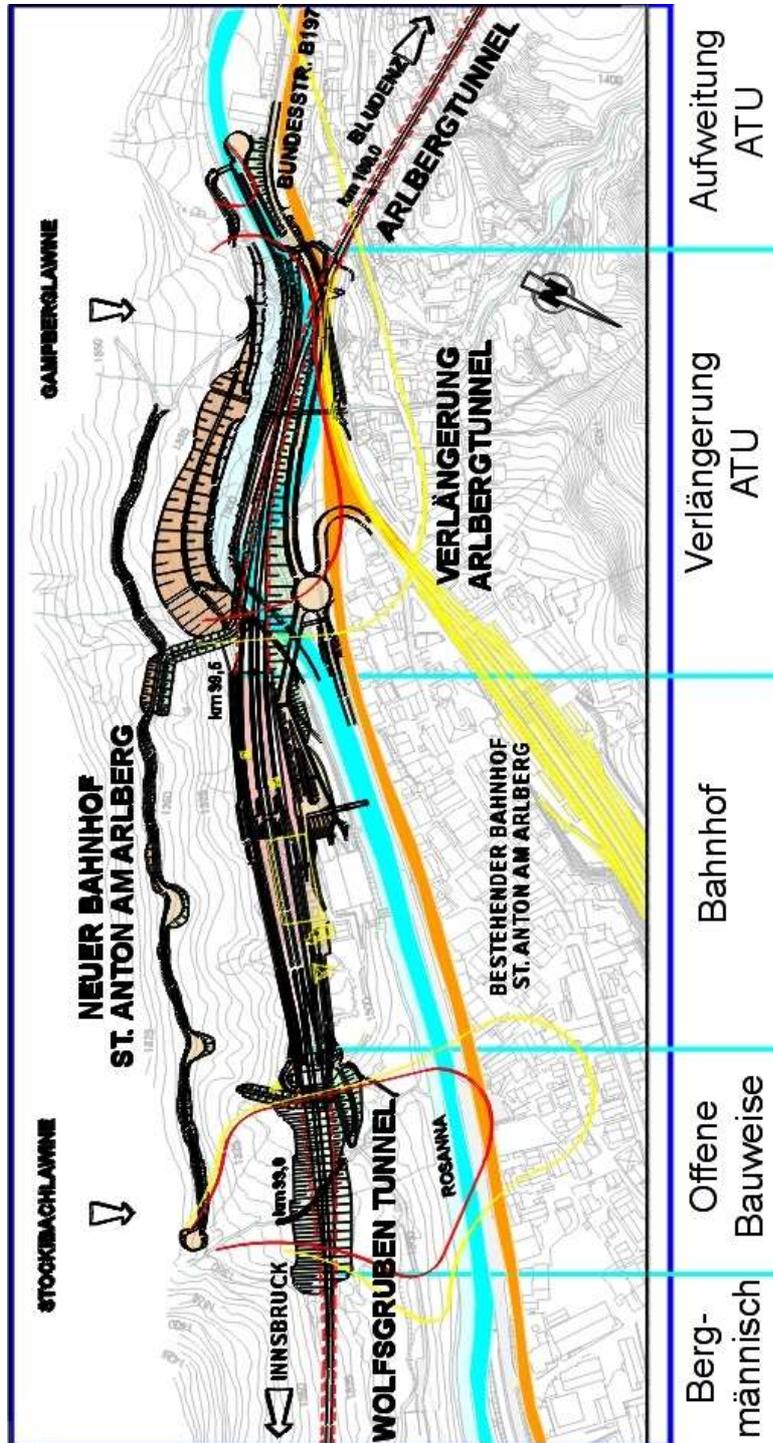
Lageplan des Bahnhofs St. Anton<sup>181</sup>
